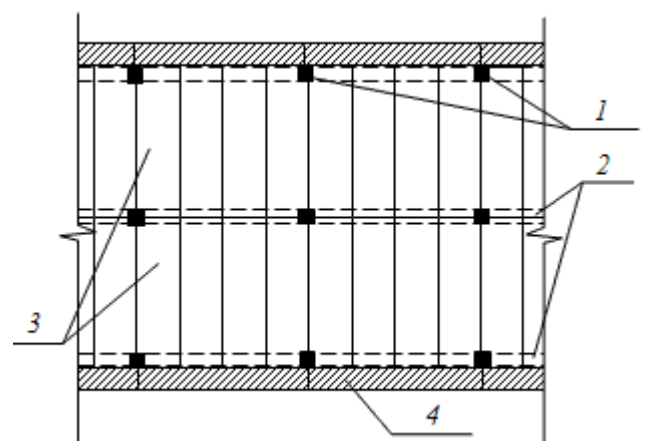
Каркасна конструктивна система: 1 – колони каркасу; 2 – ригелі каркасу; 3 – збірний настил перекриття; 4 – зовнішня навісна стінова панель
